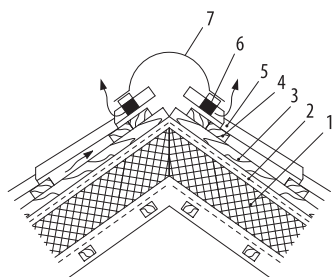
Конструкция кровли с одним вентиляционным зазором
